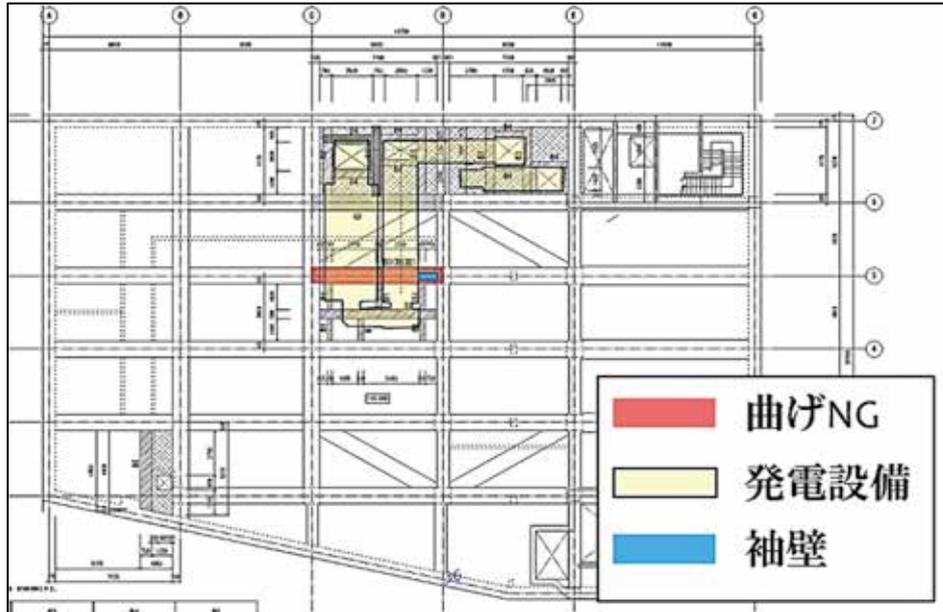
曲げ応力 NG 箇所と補強用袖壁 平面図
